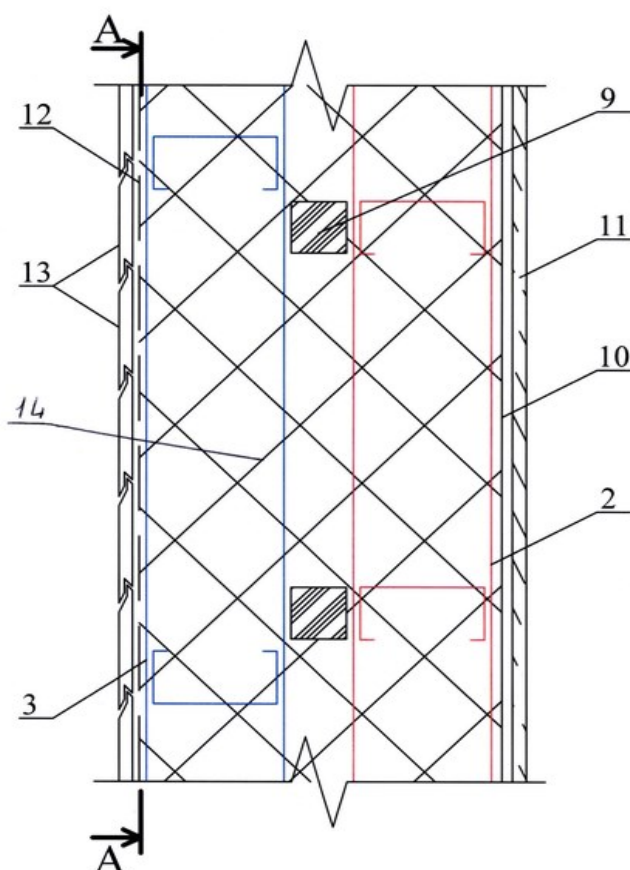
Фрагмент сечения наружной стены здания, вид сверху [3]:
